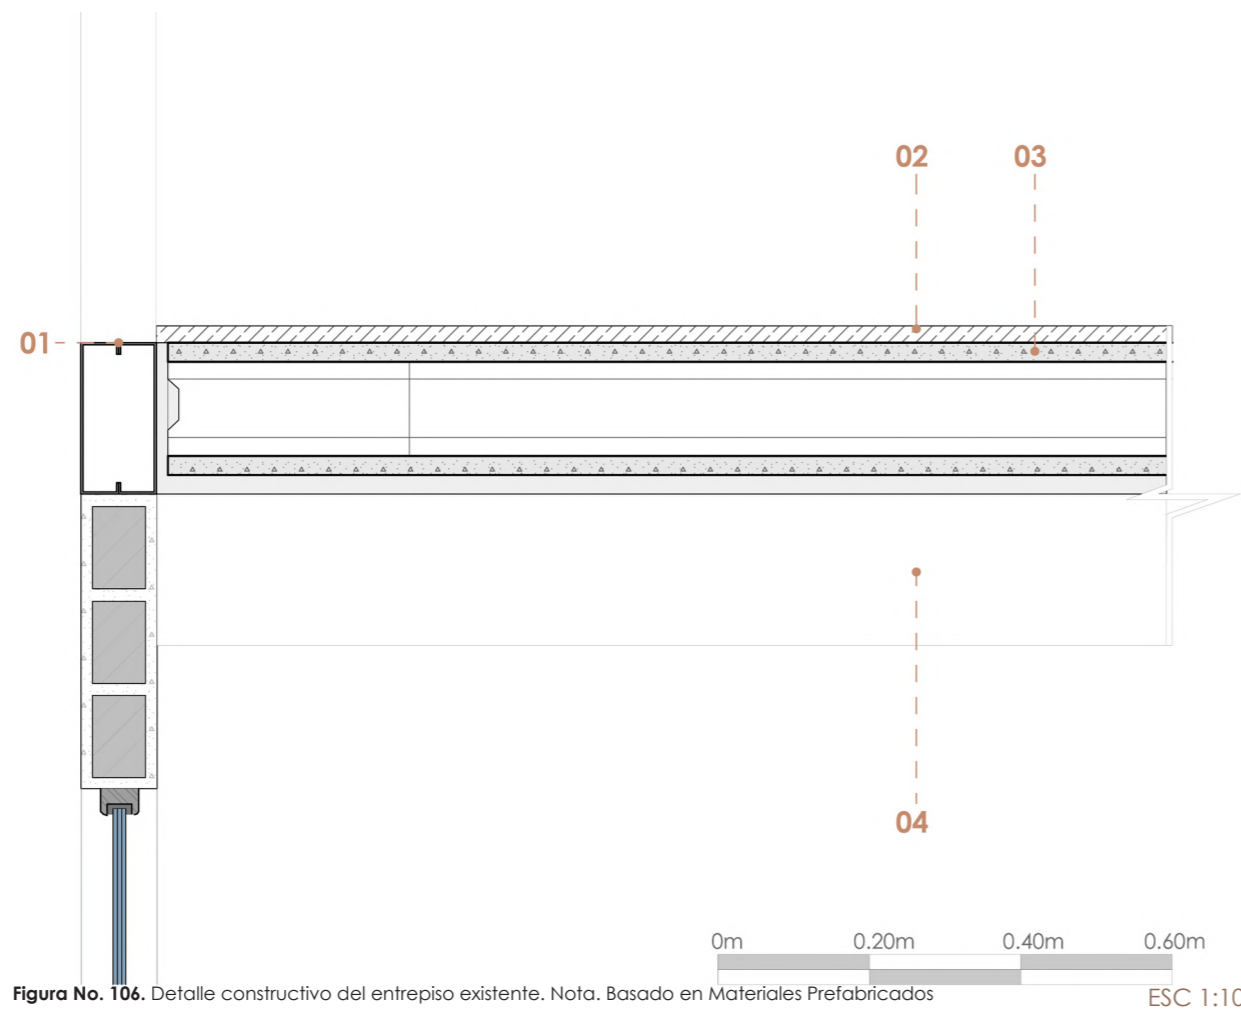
Detalle constructivo del entrepiso existente. Nota. Basado en Materiales Prefabricados
